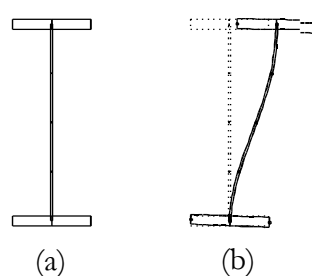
Exemple 3 : Instabilité distorsionnelle d'une section en I ? (Adany, 2004)
